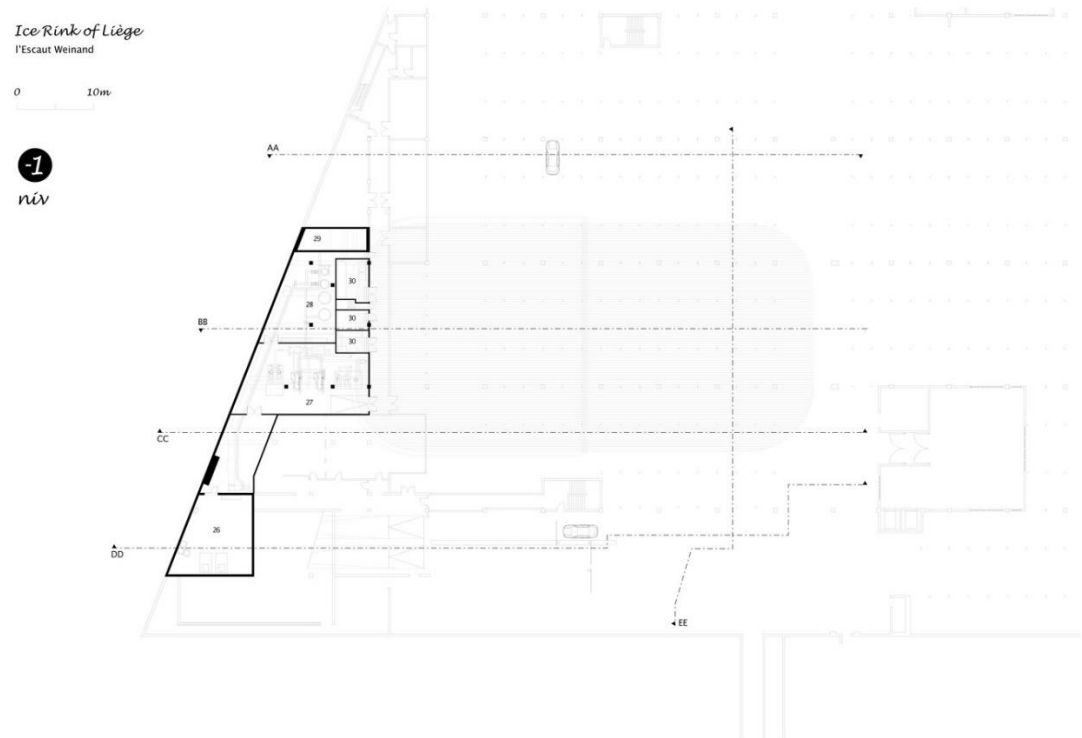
План мінус першого поверху, арх. L'Escaut Architectures + BE
